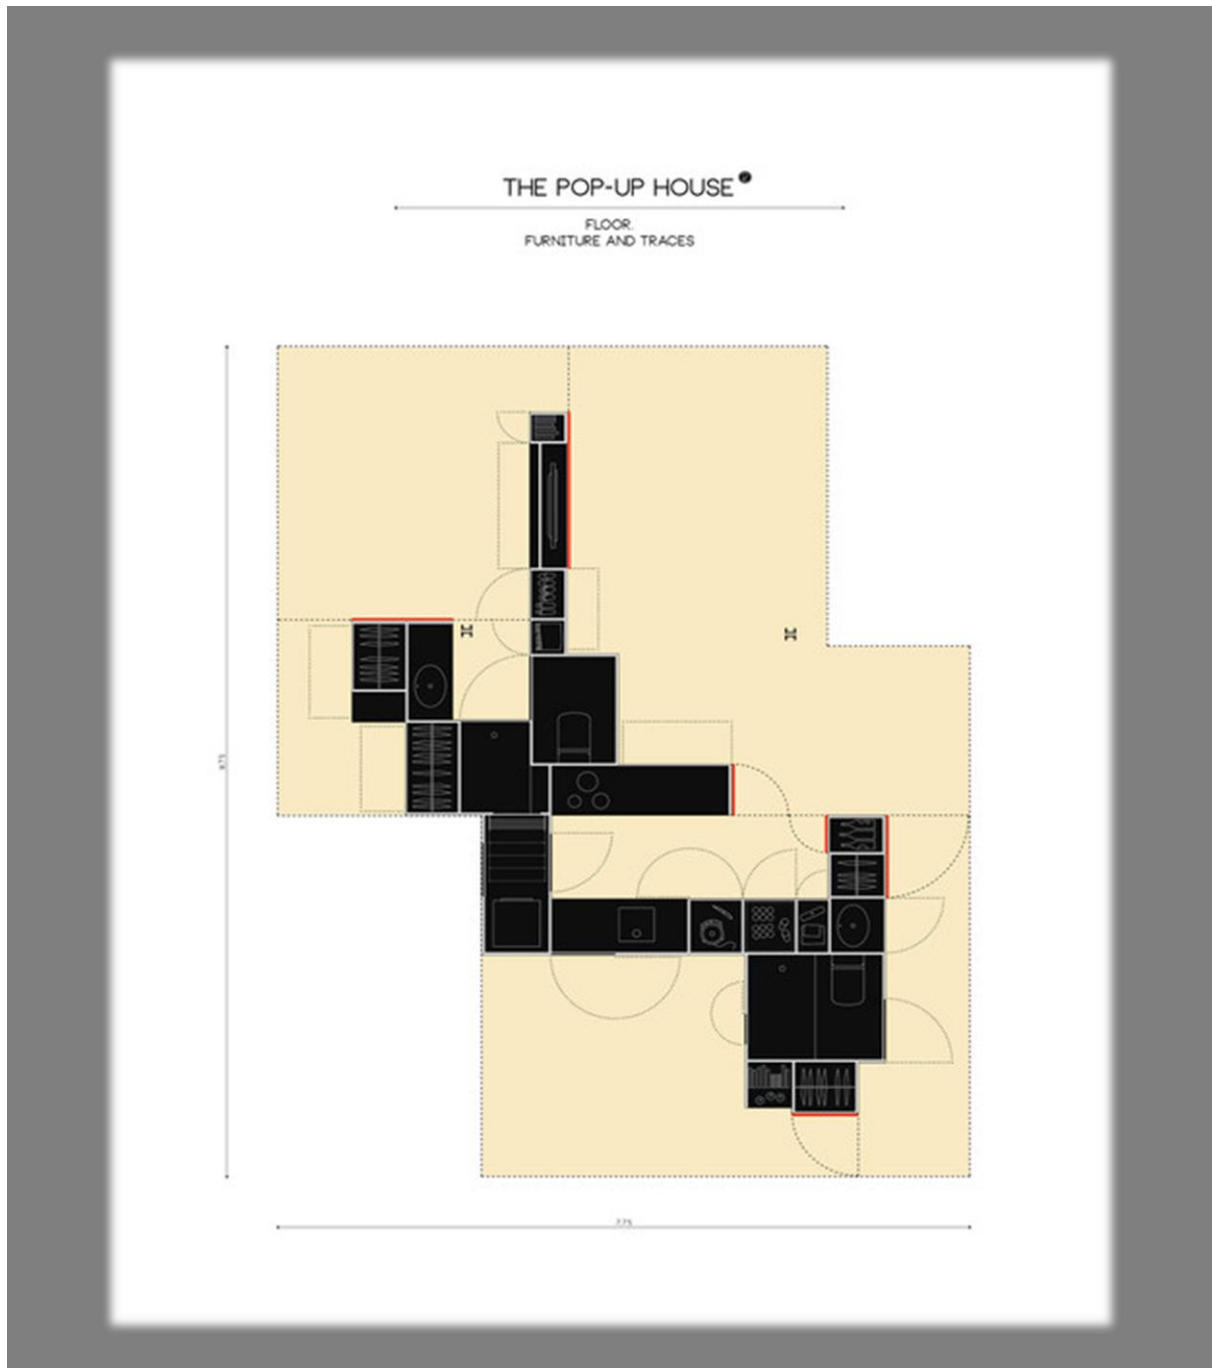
Planta de distribución espacial de la Infraestructura. Fuente: Revista digital ArchDaily México. Accedido el 15 Abr 2022. <<https://www.archdaily.mx/mx/758987/the-pop-up-house-tallerde2-arquitectos>>
